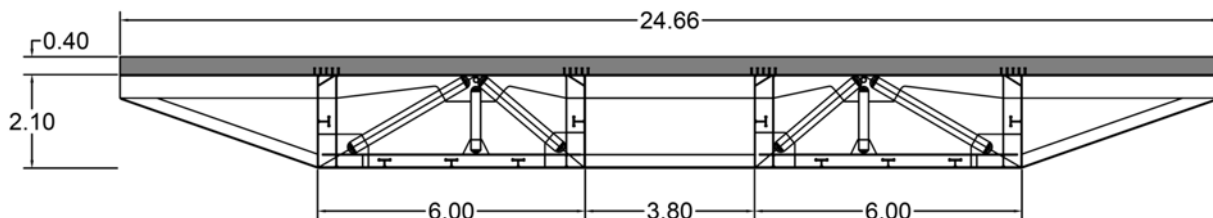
Sección transversal entre pilas en zona de conexión con escaleras.
